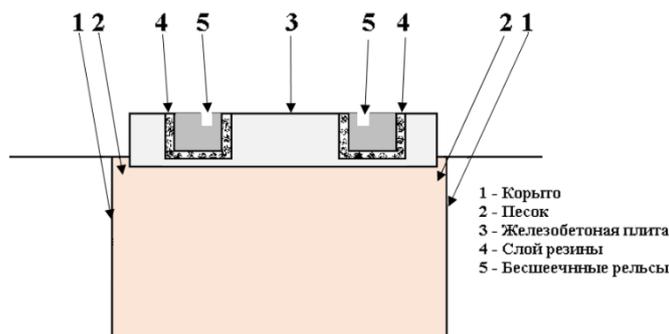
Бесшпальная конструкция путей с бесшпальными рельсами
